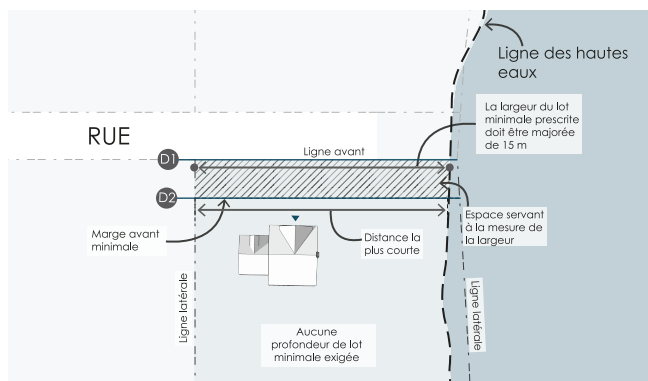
Largeur minimale d'un lot dont la ligne avant n'est pas sensiblement opposée à la ligne des hautes eaux
